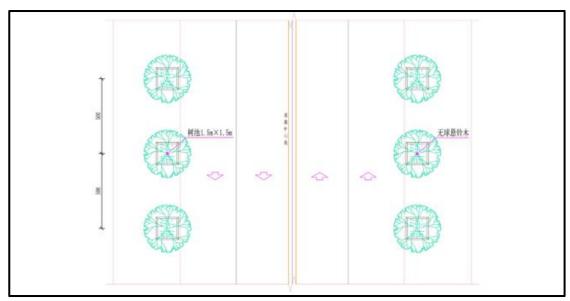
项目绿化标准段平面图 (瑜城路~三河路)
